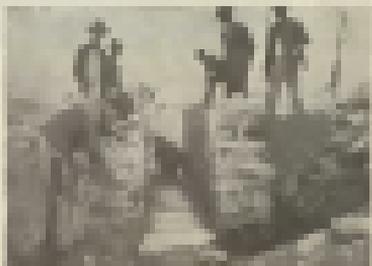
Trabalho de terra para a construção da Estação de São Paulo
